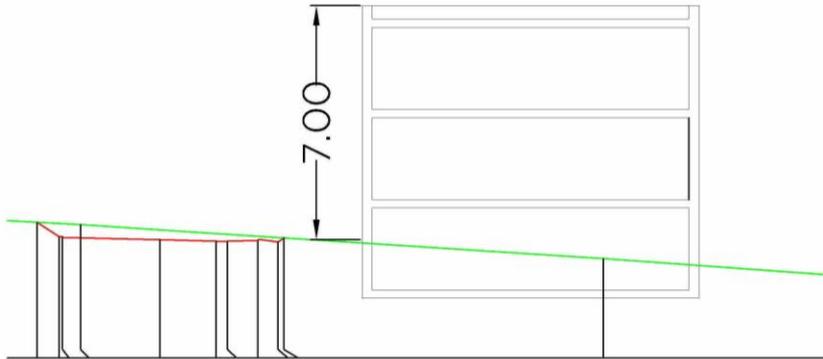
Systemschnitt zur Definition des Bezugspunktes für Flachdach
